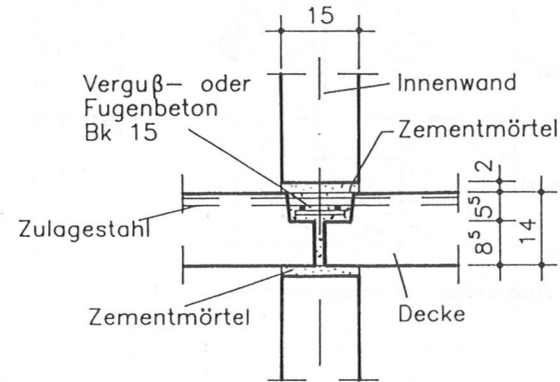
Verbindung tragende Innenwand - Decke
